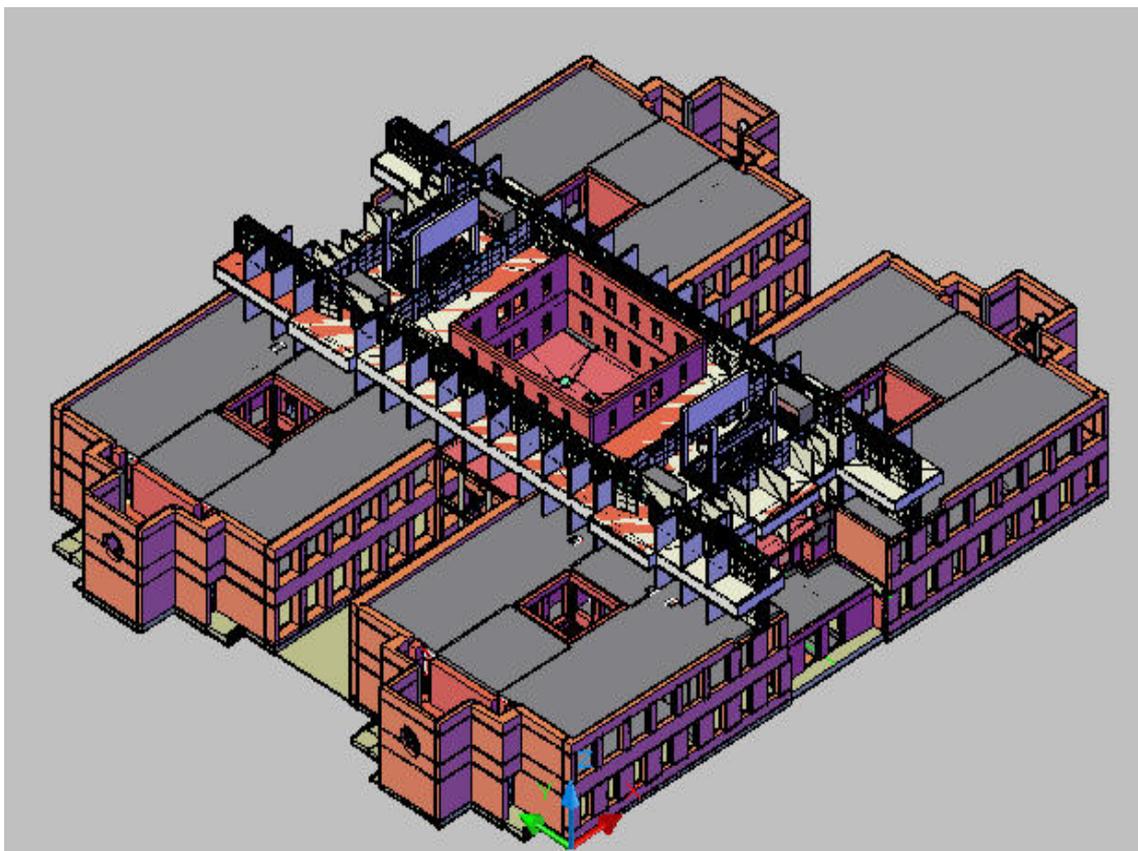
Estructura interna de la Planta 2
